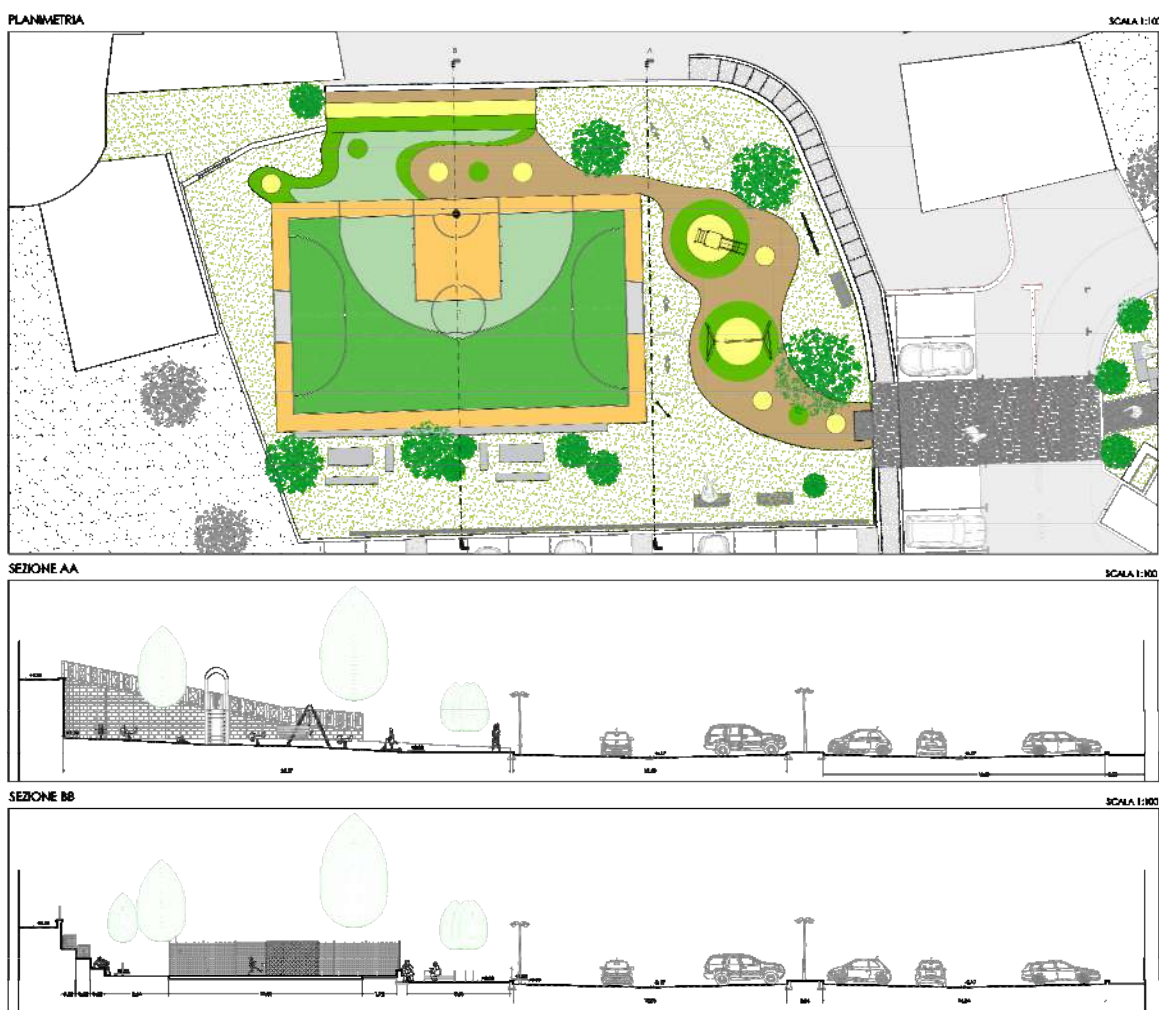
Planimetria generale di progetto parco giochi “Valle Pierina”
